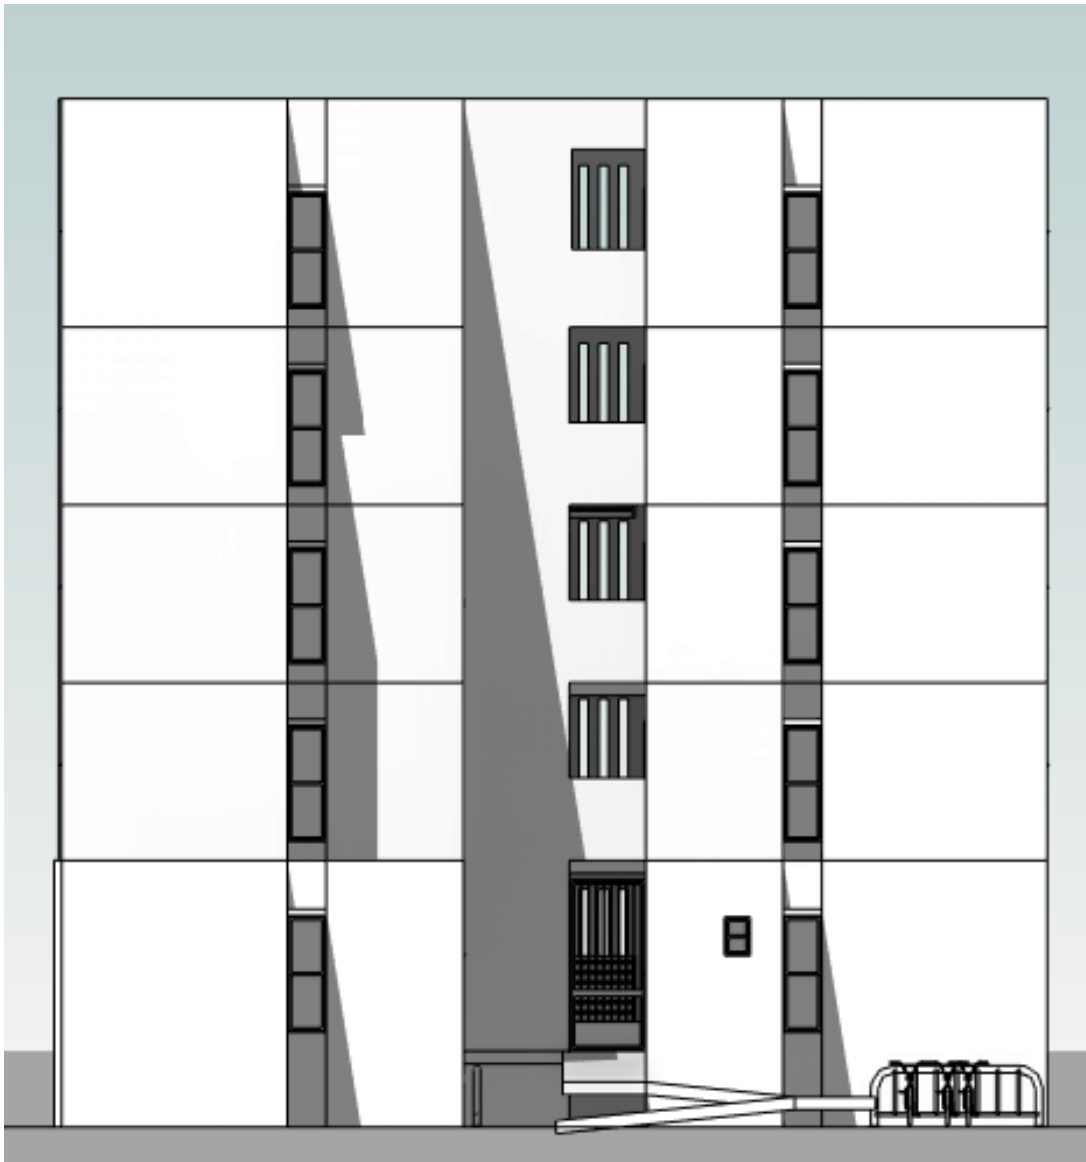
Fachada Sureste a las 12:00 p.m.
